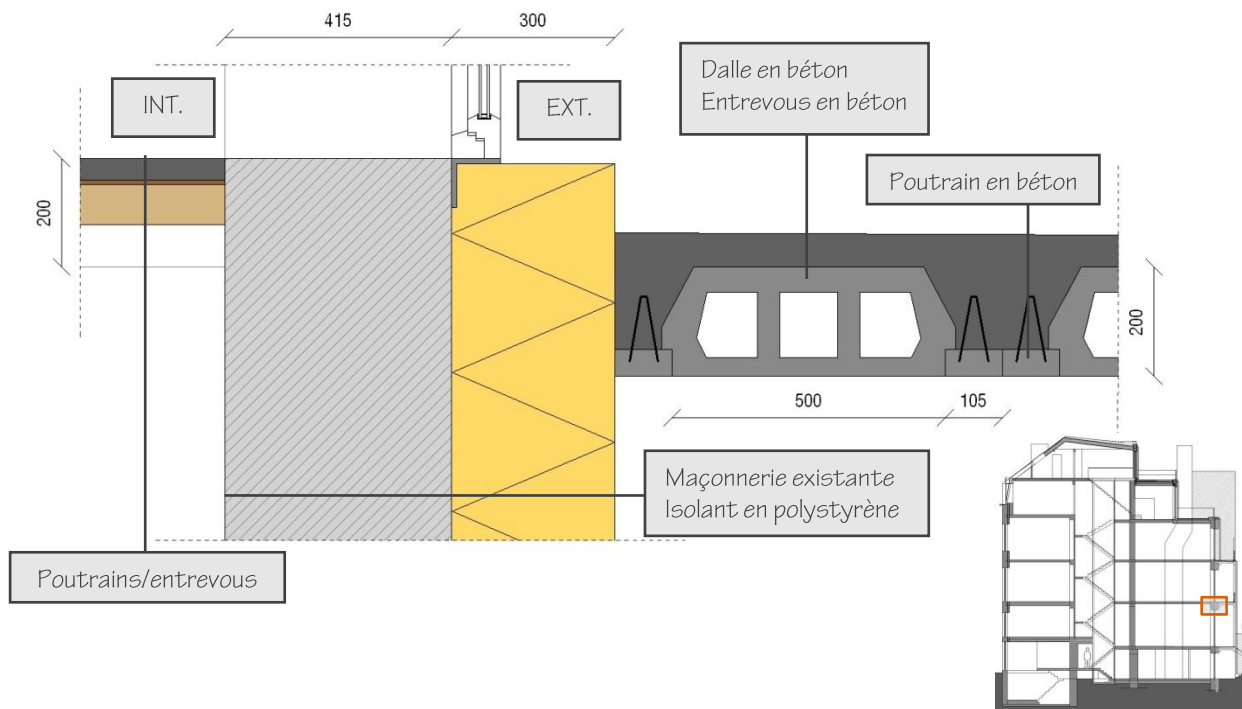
Détail de l'isolation par l'extérieur de la façade arrière, mesures en [mm]
